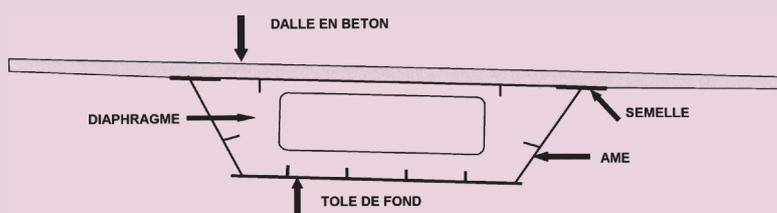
Caisson à pièces de pont sans console (cas d'une chaussée monodévers)
